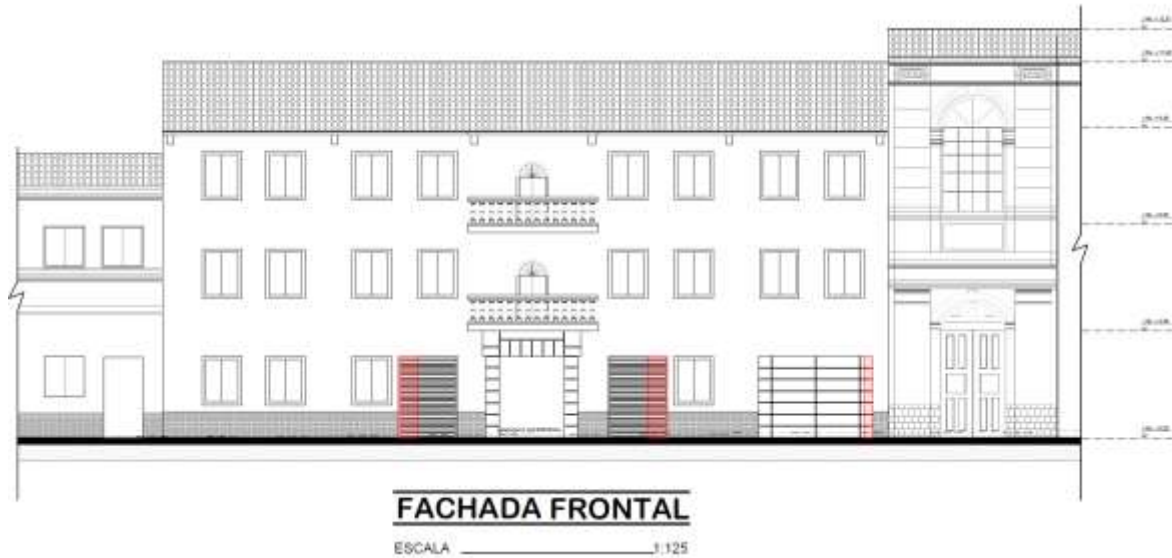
Fachada frontal de la edificación, se marcan los añadidos arquitectónicos que dañan la imagen de la misma
